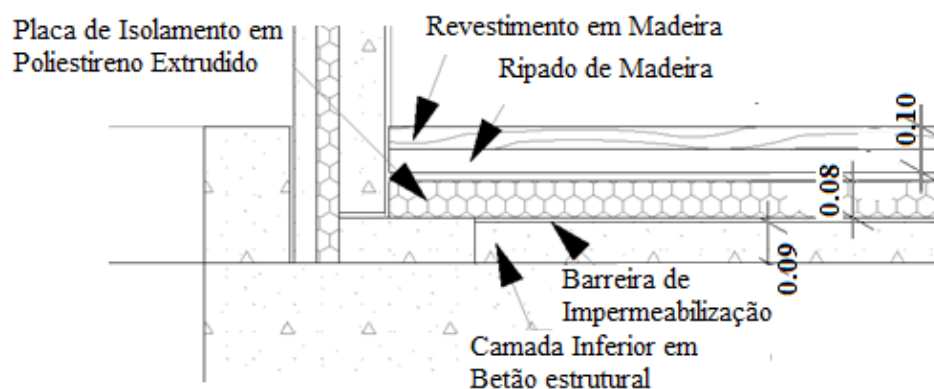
Pormenor da seção tipo do Pannel de Piso.
